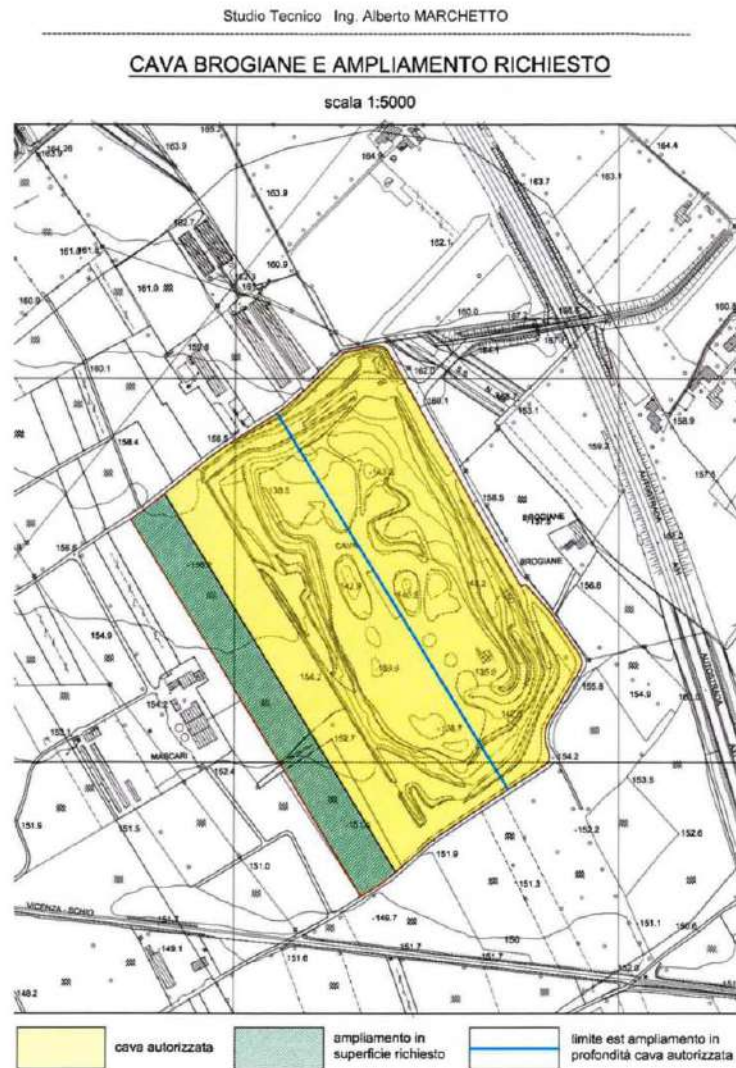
PLANIMETRIA AMPLIAMENTO DI CAVA.
